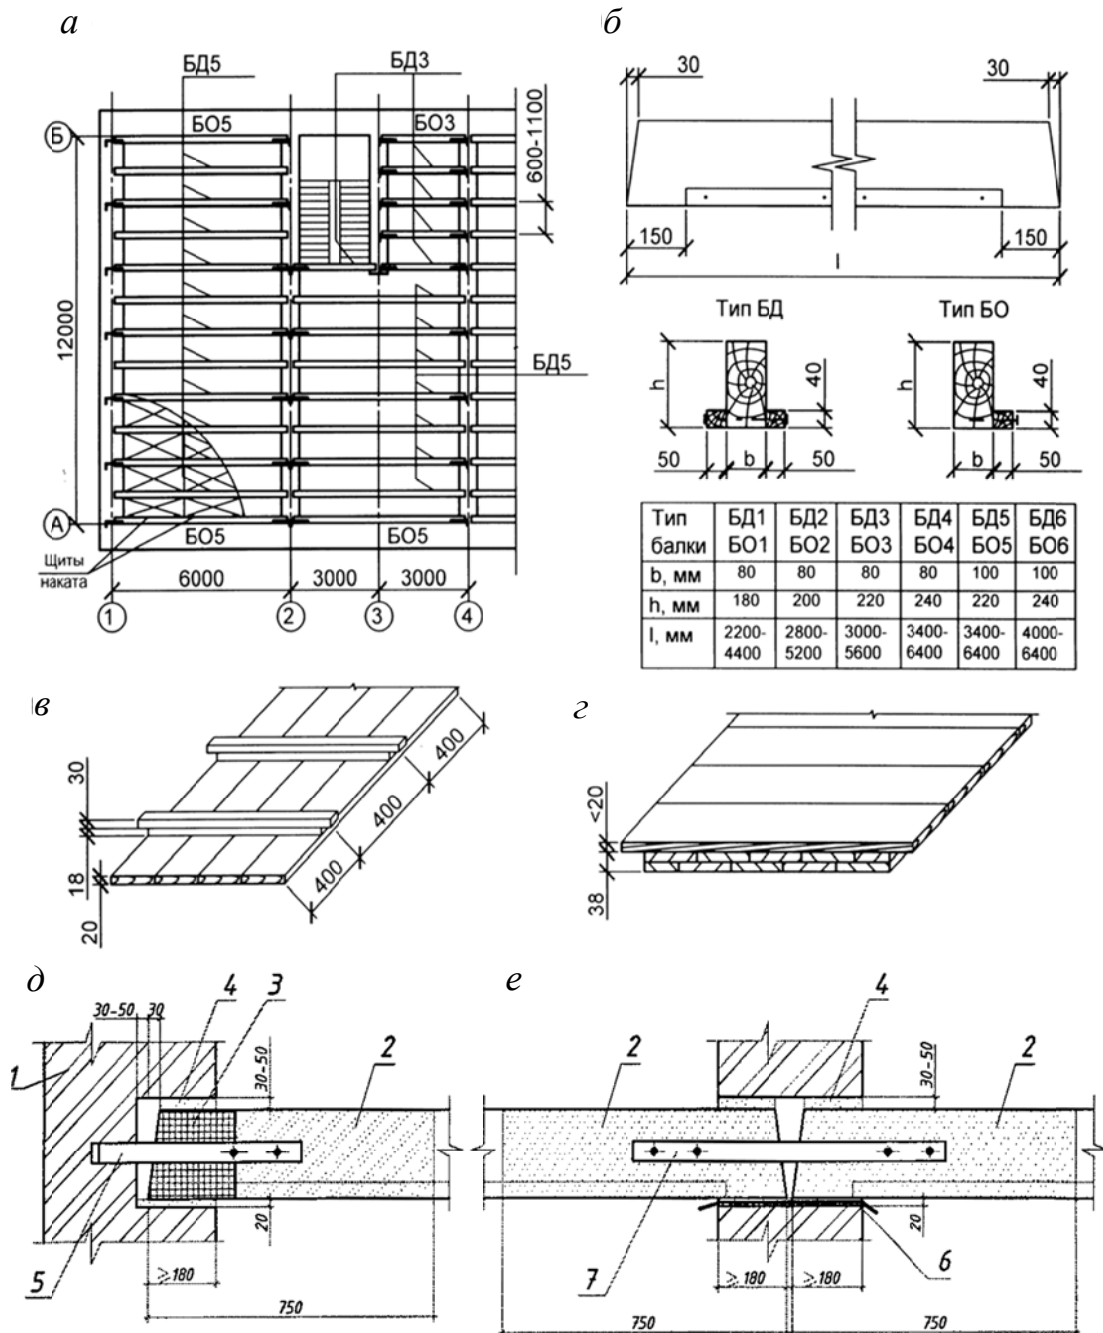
Перекрытия по деревянным балкам с черепными брусками:
